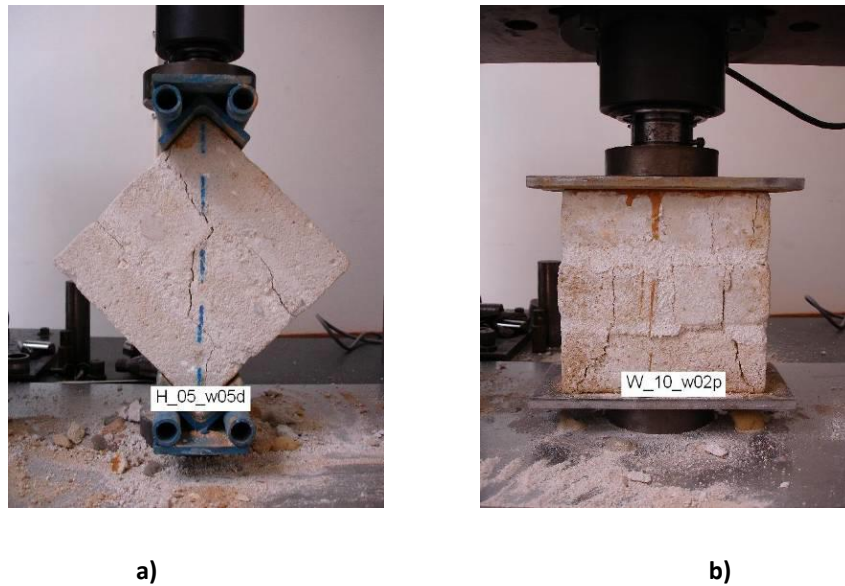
Ensaios em muretes de adobe: a) Ensaio em compressão diagonal b) Ensaio em compressão perpendicular (Henrique – 2008)
